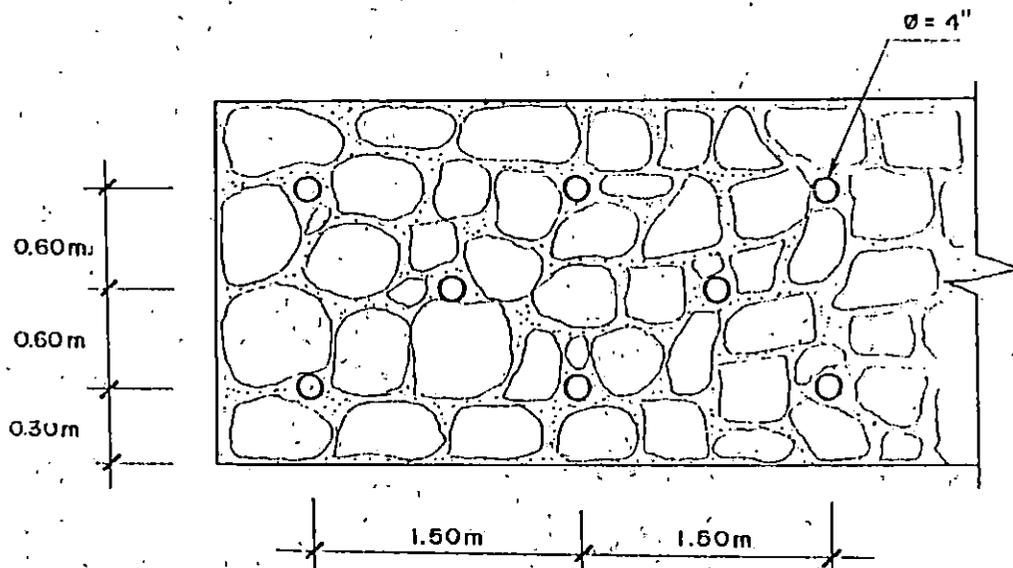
Elevación de un muro de mampostería mostrando la distribución de drenes
